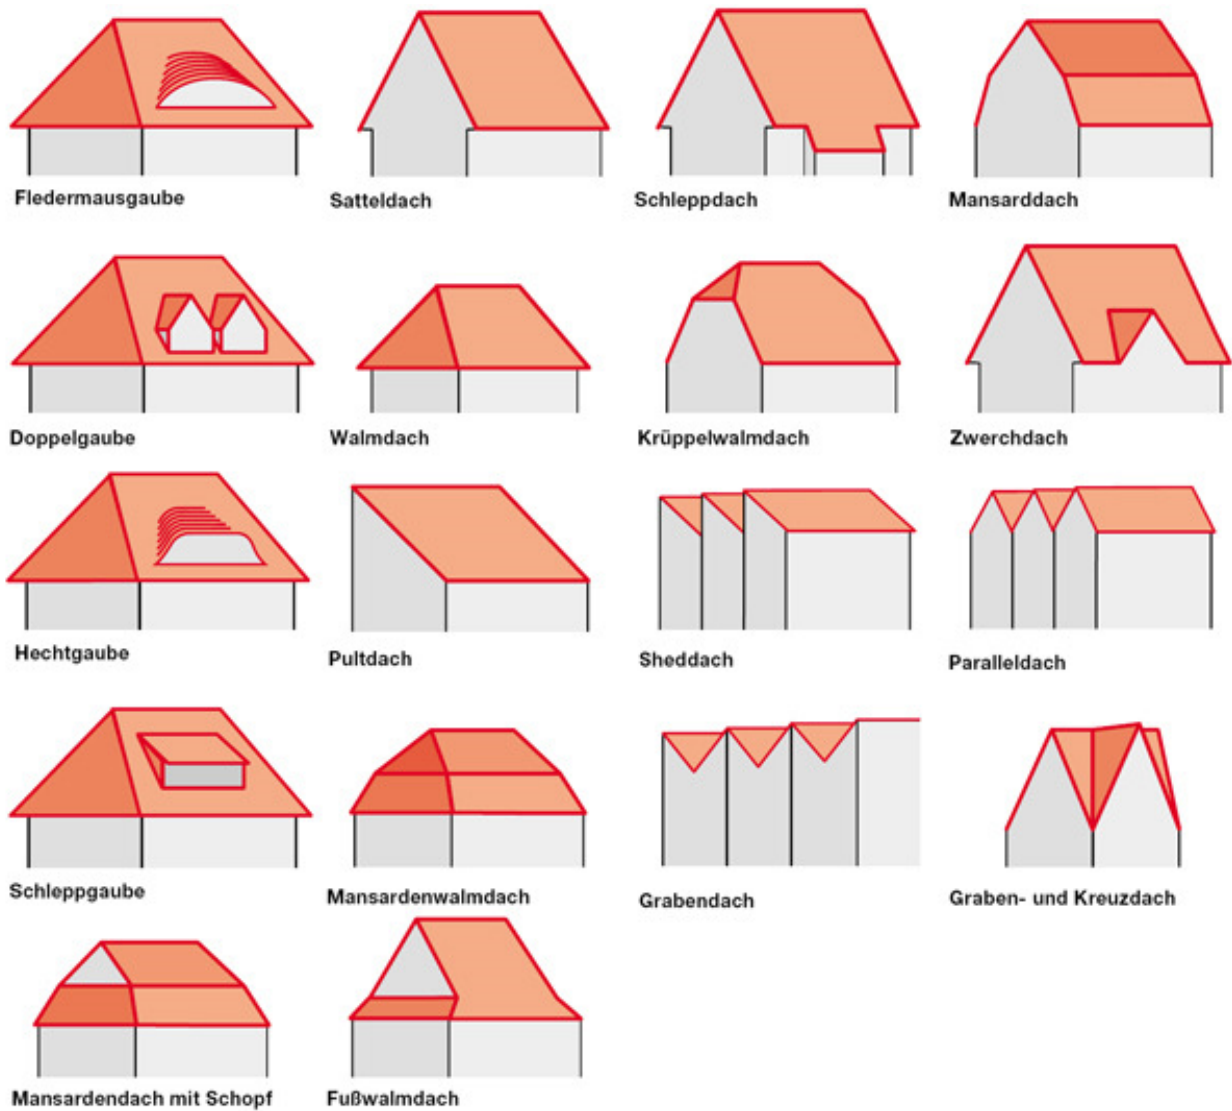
Schematische Darstellung verschiedener Dachformen (Quelle: Dachdeckerforum)
